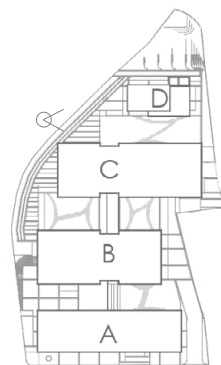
Planta Baja A-B. Fuente: Autoría propia.
